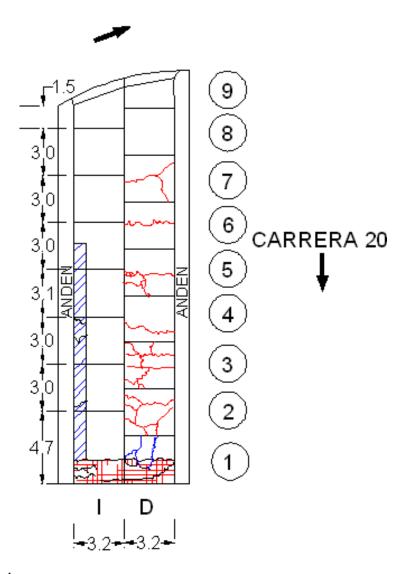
Ejemplo del tramo C 32 pavimento flexible dibujado en AutoCAD.
